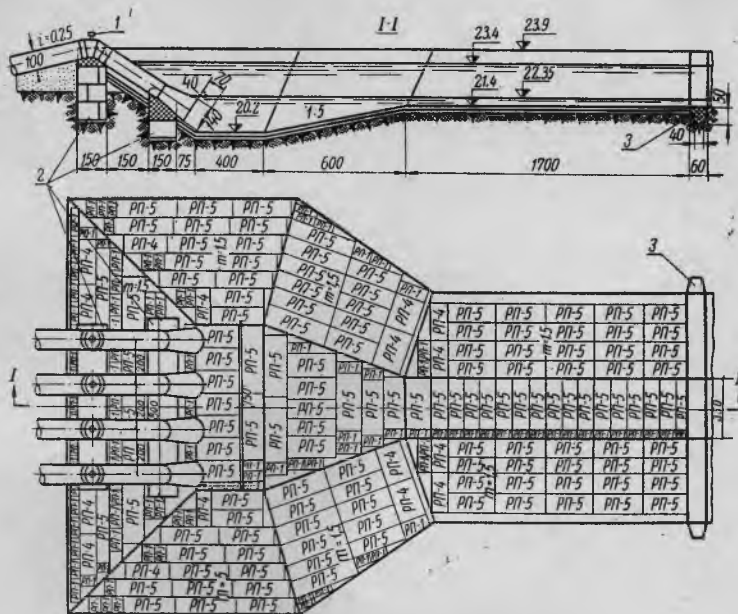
Прямоточный водовыпуск сифонного типа с четырьмя сифонами без нижнего отвода из металлических труб с раскладкой плит крепления:
